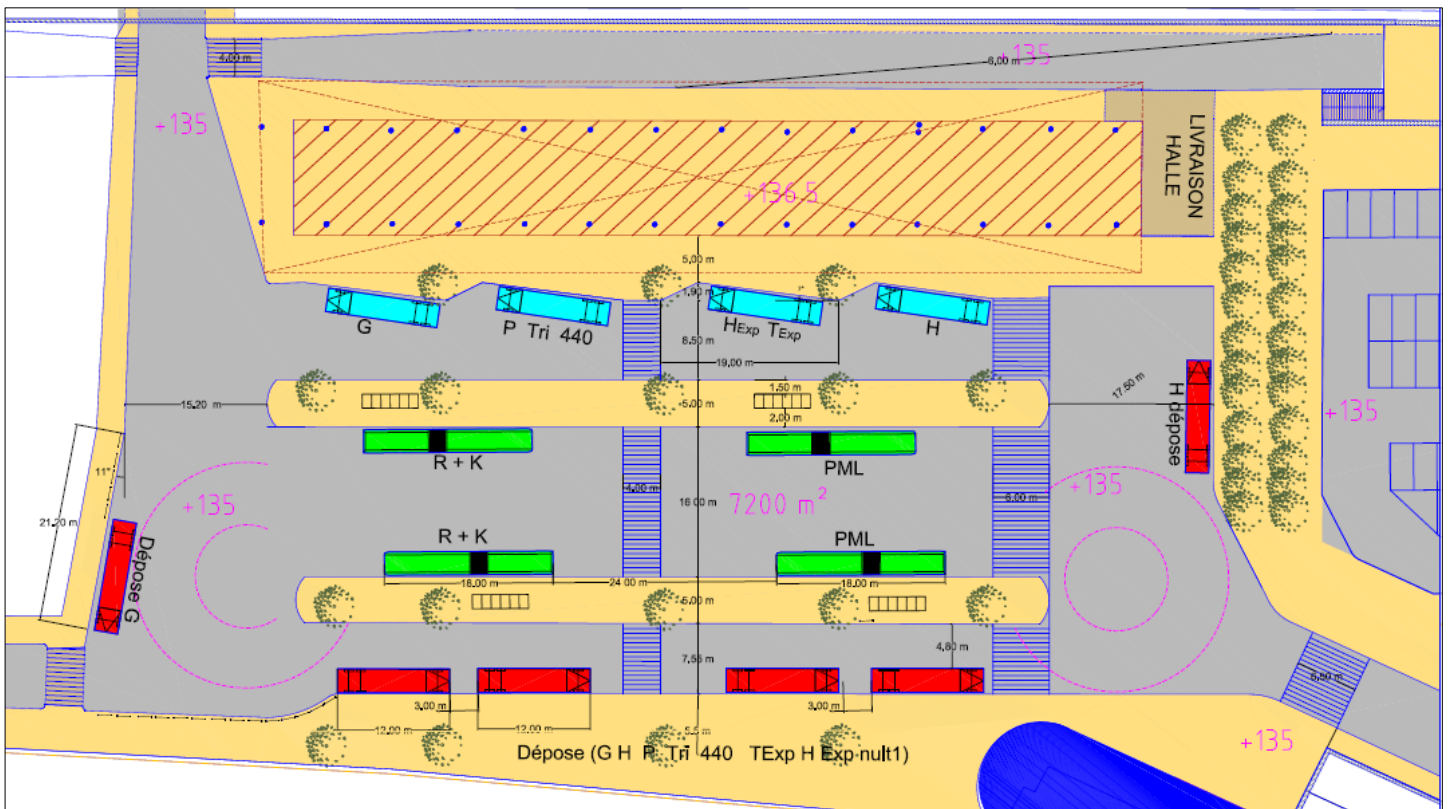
Plan d'aménagement de la gare routière intégrée au PEM de Versailles Chantiers
